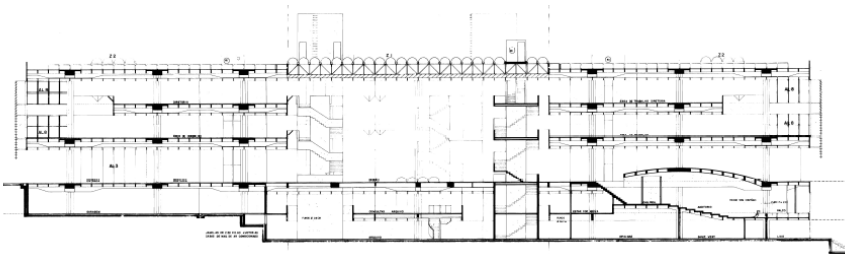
Edifício Sede da Eletrosul: corte do projeto original seccionando o átrio central
